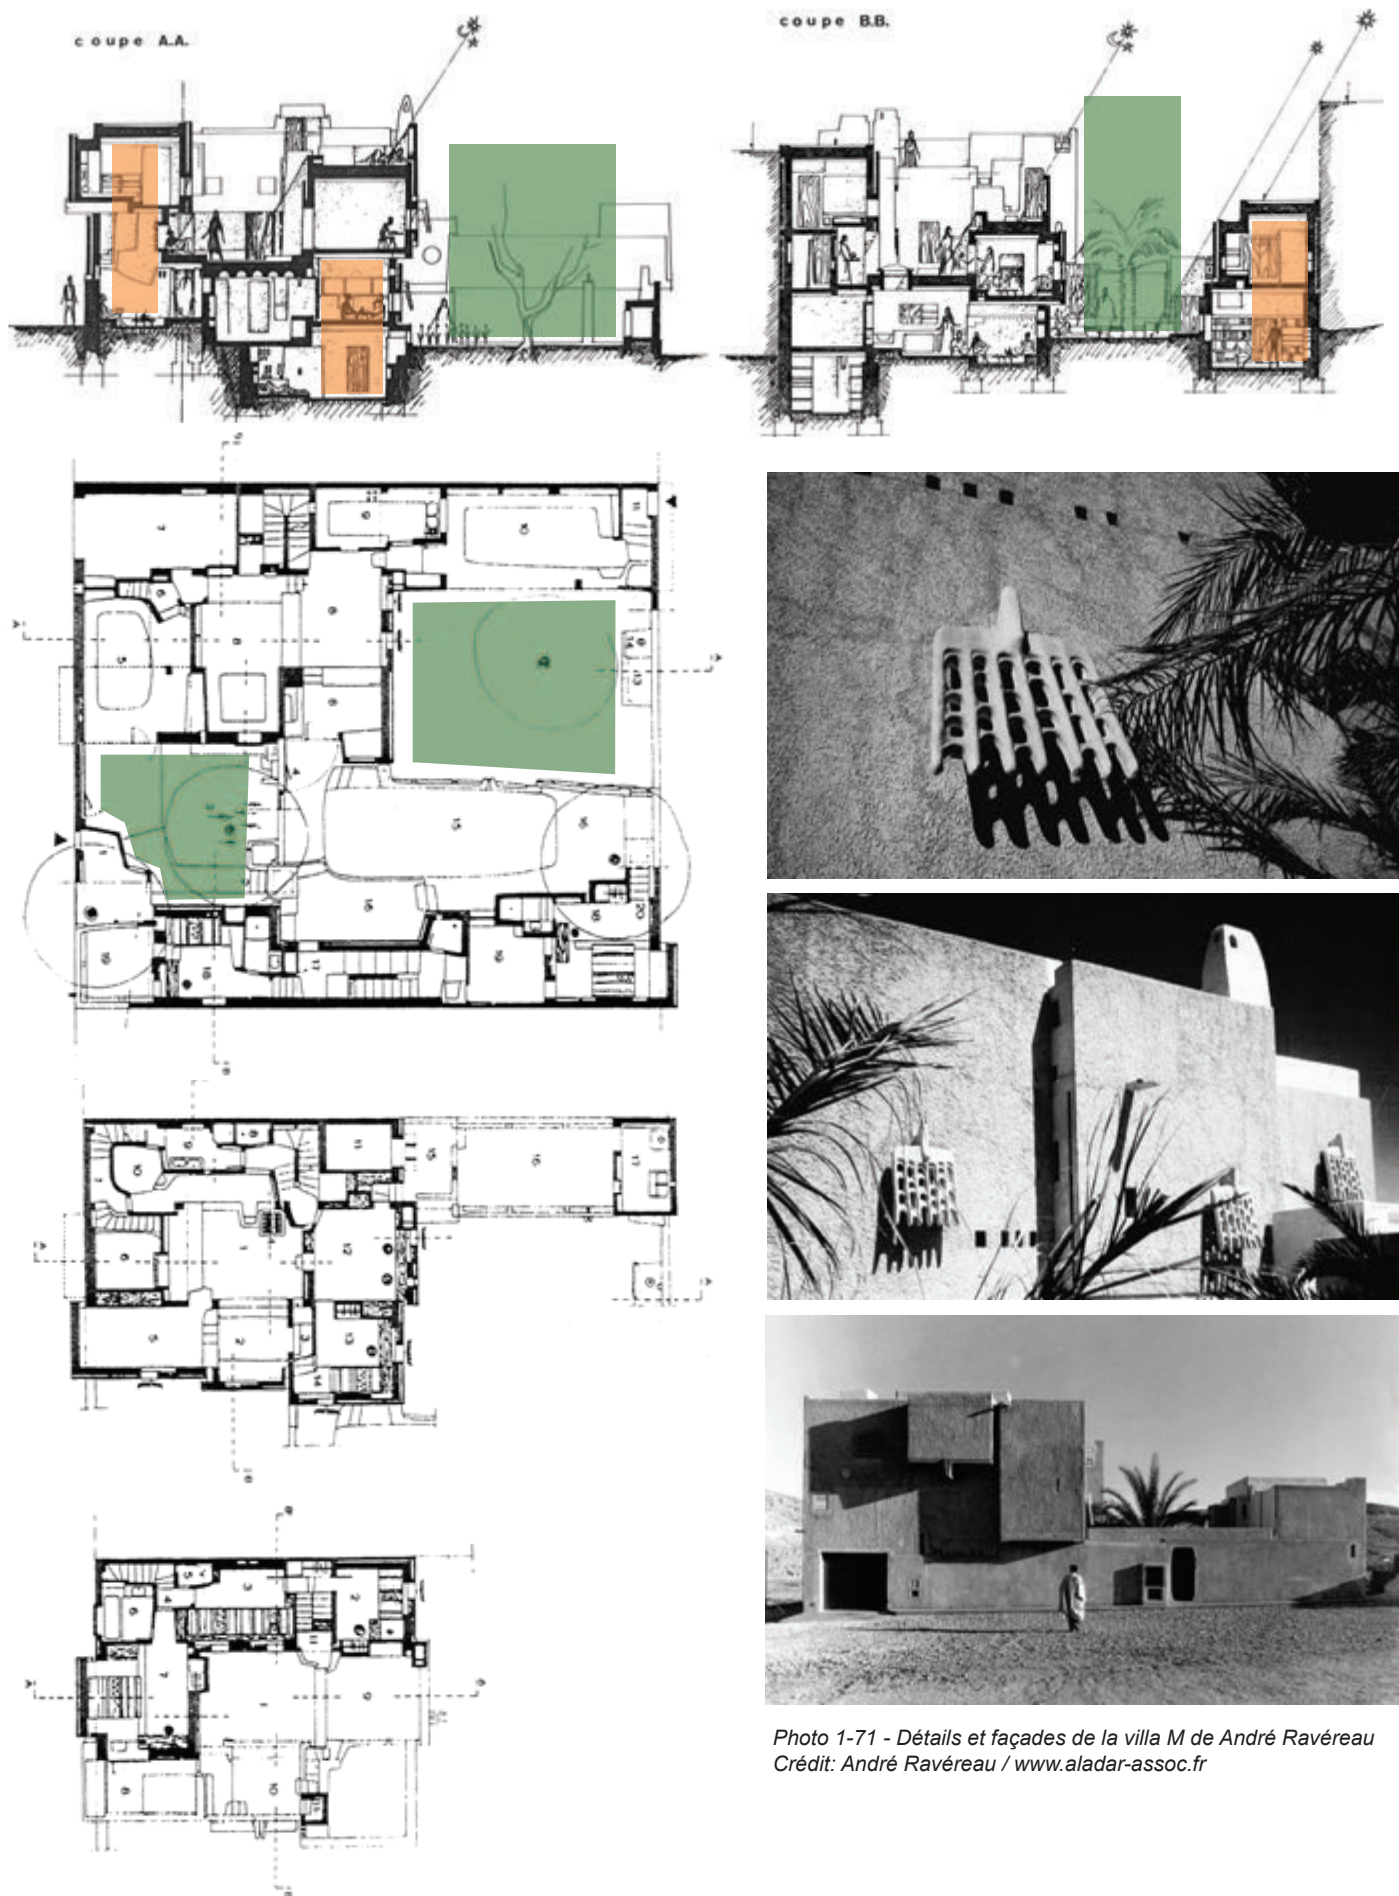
Détails et façades de la villa M de André Ravéreau
